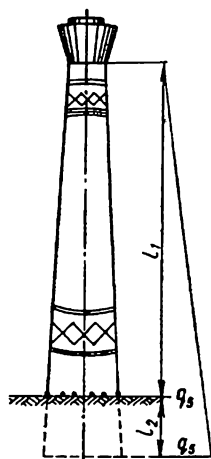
Определение крена дымовых труб методом проектирования по вертикальной нити теодолита.
